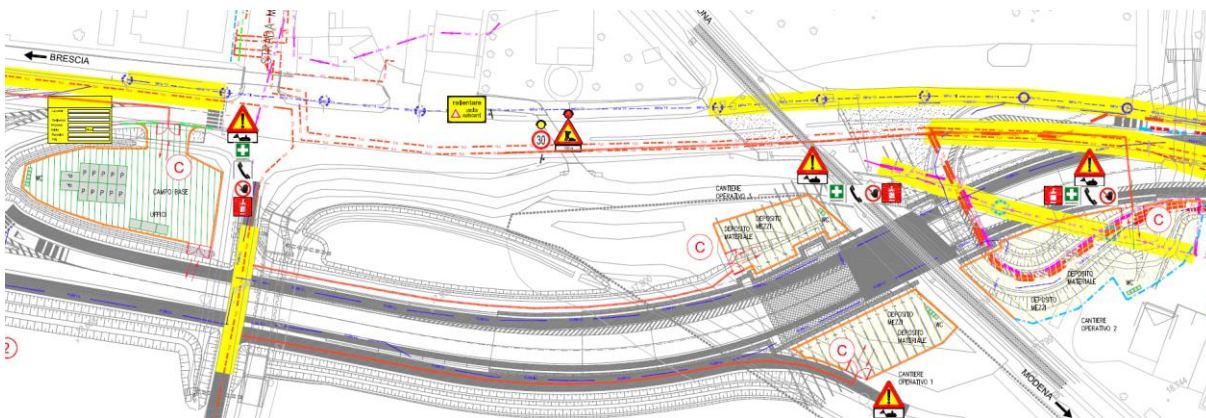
Layout Cantiere Base e Cantieri Operativi 1, 2 e 3.
